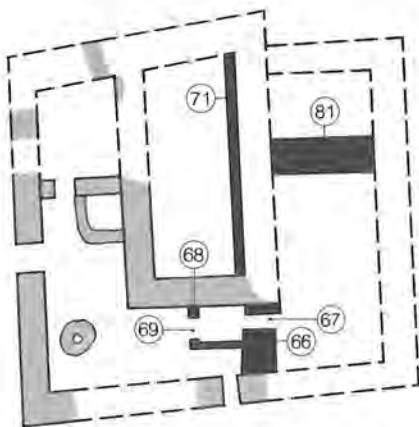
Grundriss mit Eintrag der undatierten Befunde.
